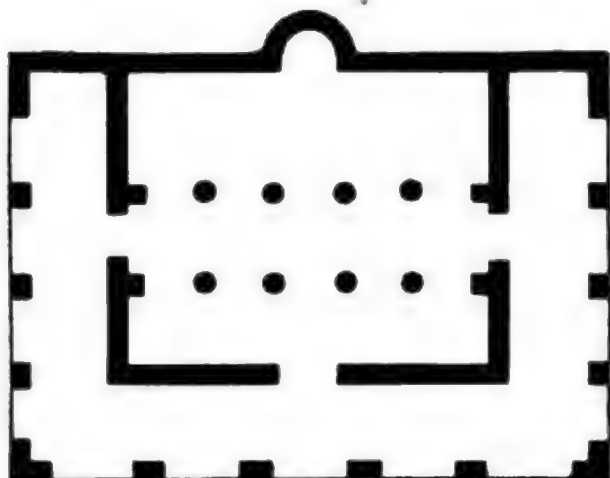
Planta de la mezquita de Koser-il-Hallabat.
